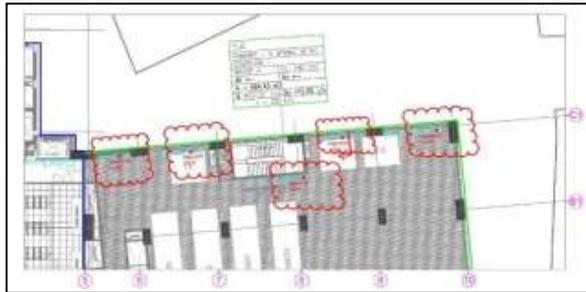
Pemasangan Siphonic Roof Outlet (Tampak Atas)
